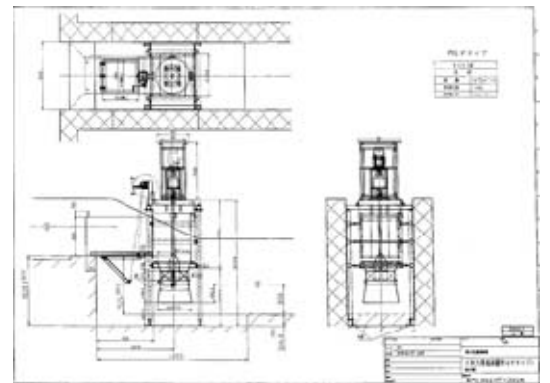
設備設計図及び施工状況 (第 3 落差工)
